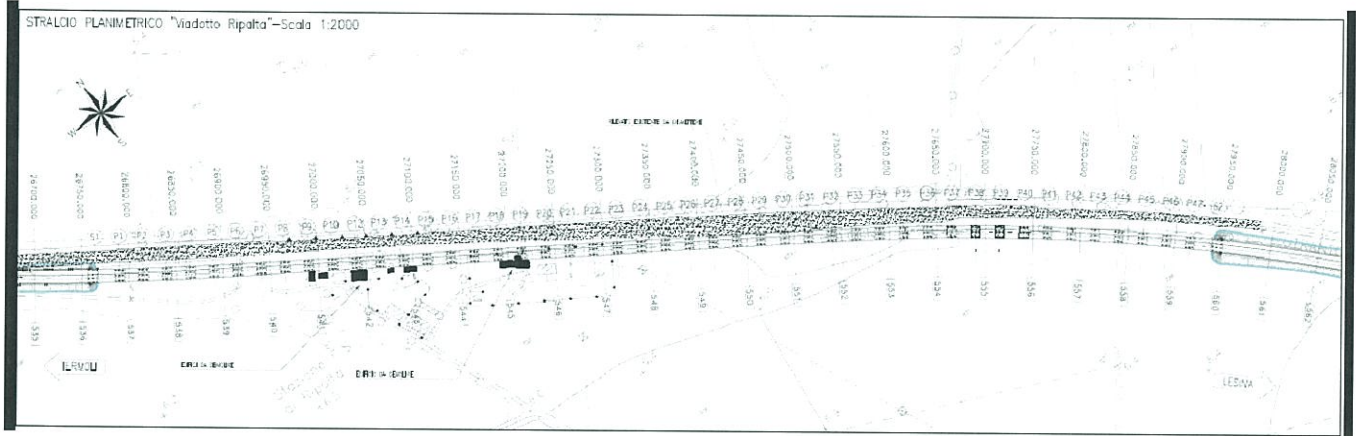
Viadotto Ripalta: stralcio planimetrico
